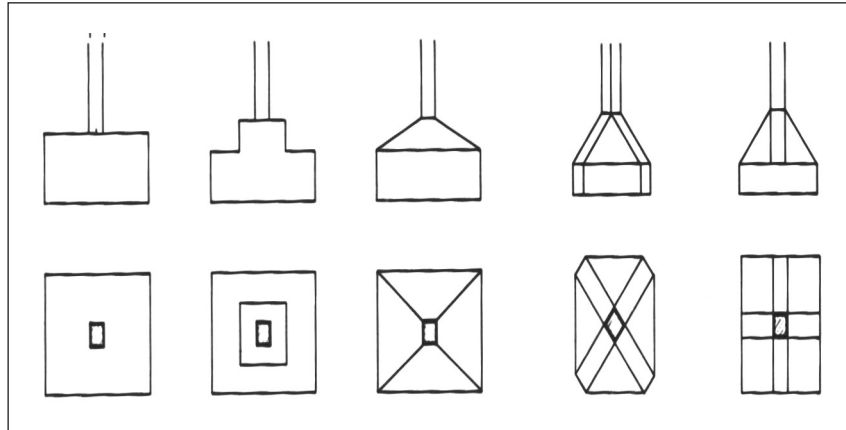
EJEMPLOS DE ZAPATAS EN PILAS.
